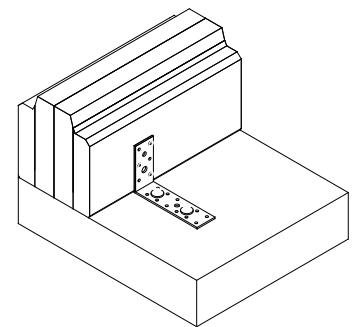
Chapa metálica para ligação entre o primeiro toro e a base de fundação
